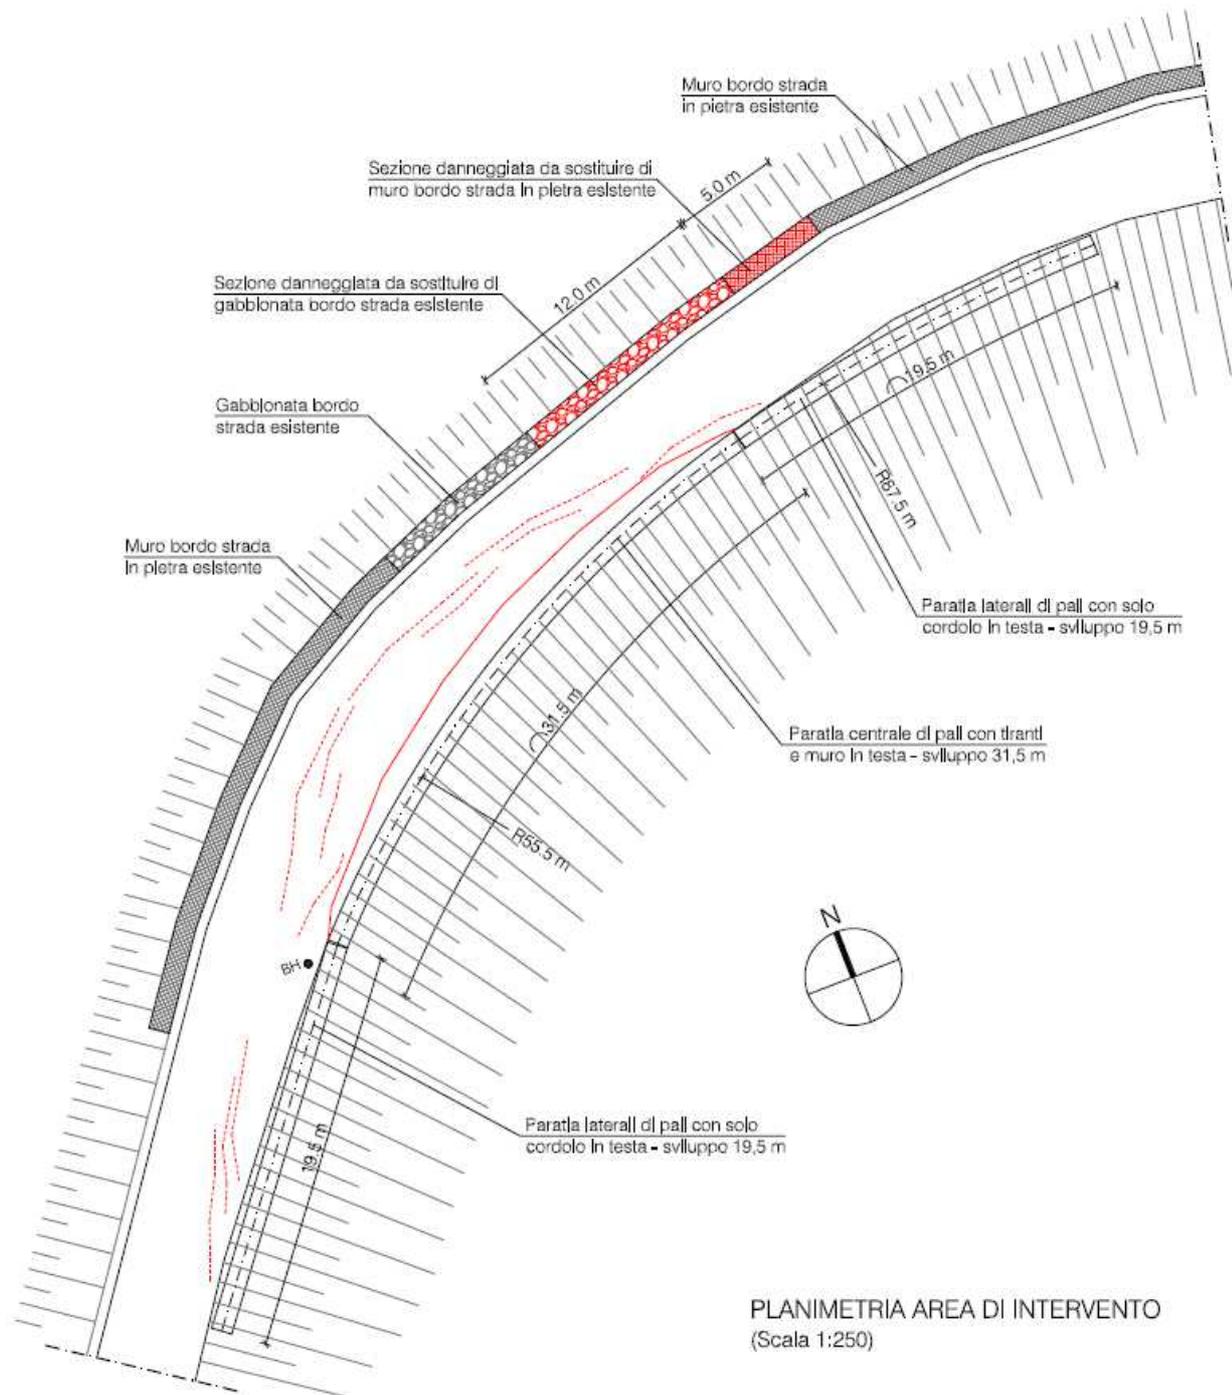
Planimetria d'intervento con indicazione delle opere.
